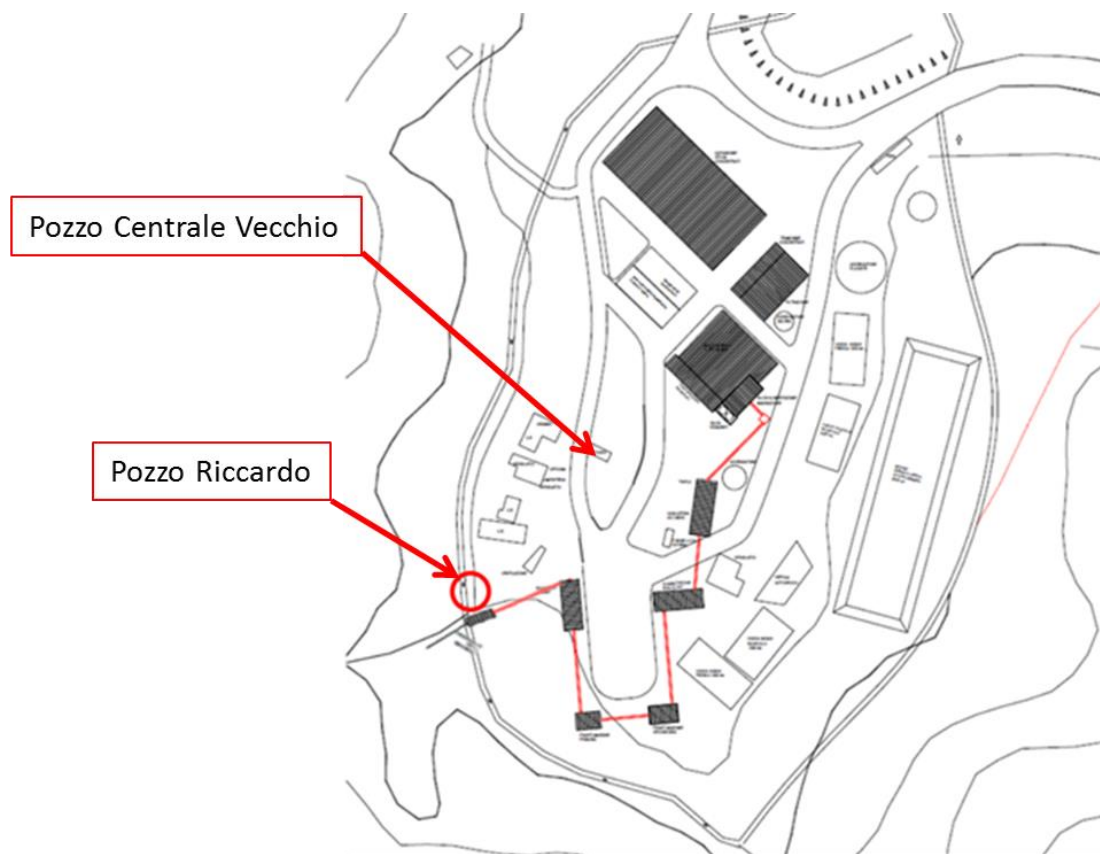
Planimetria schematica del nuovo impianto con indicazione dell'attuale (Pozzo Centrale) e del futuro (Pozzo Riccardo) pozzo di estrazione
